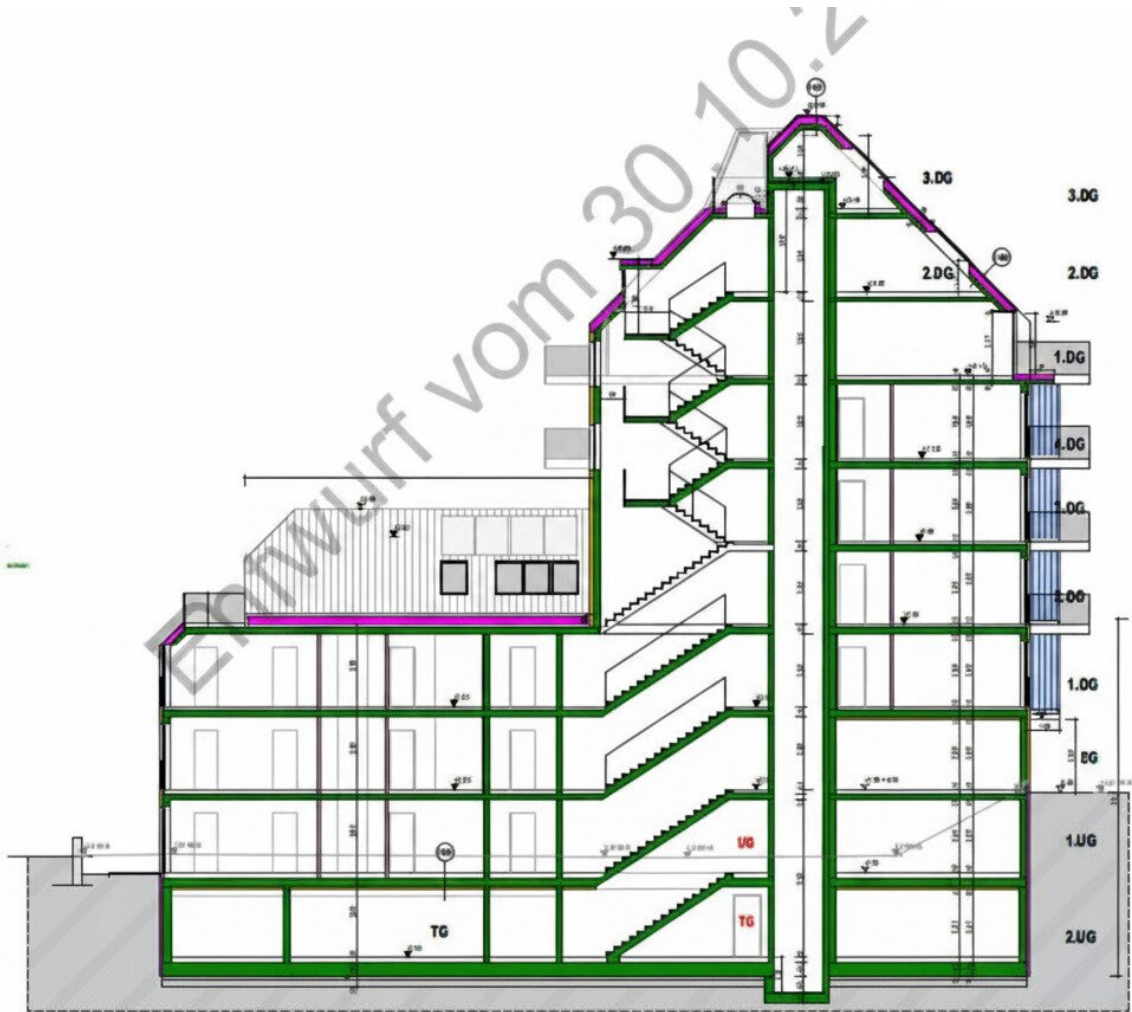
Auszug aus Einreichplan Plan Nr.: WAGR68.EP 02 vom 10.10.2023
